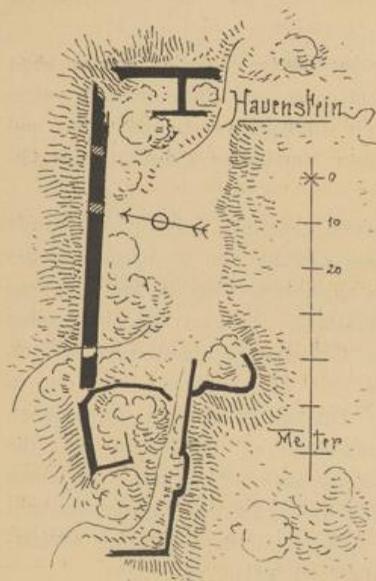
Hauenstein. Grundriss der Burg.
